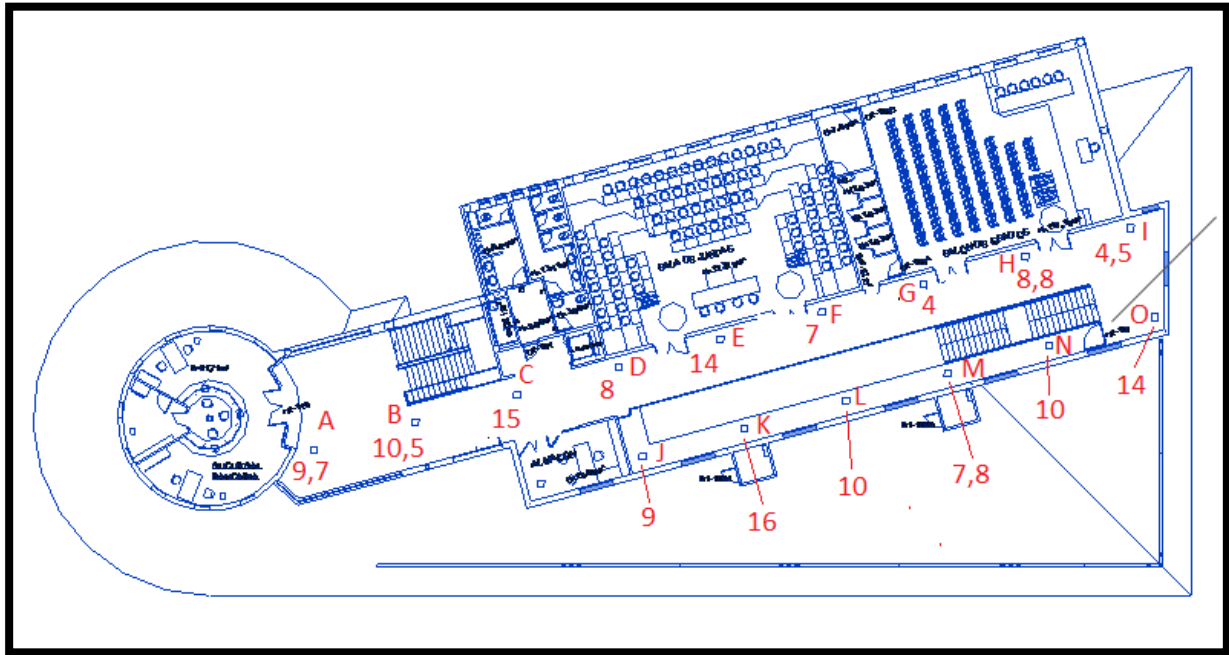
Plano de la primera planta con las precisiones de las columnas en mm con los nuevos resultados.
